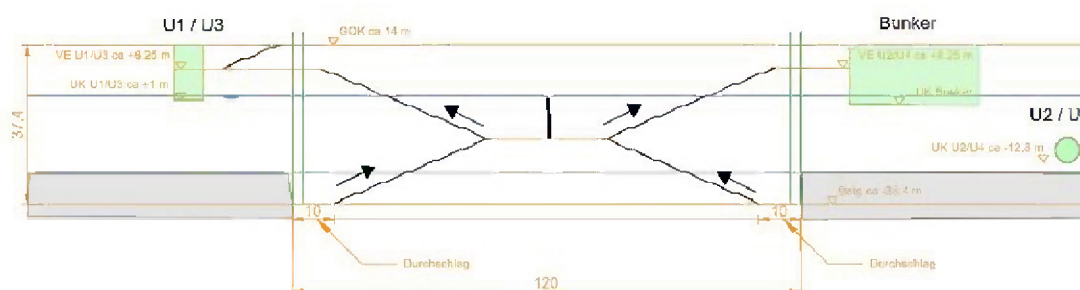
Längsschnitt Haltestellenlayout Hauptbahnhof Kirchenallee
